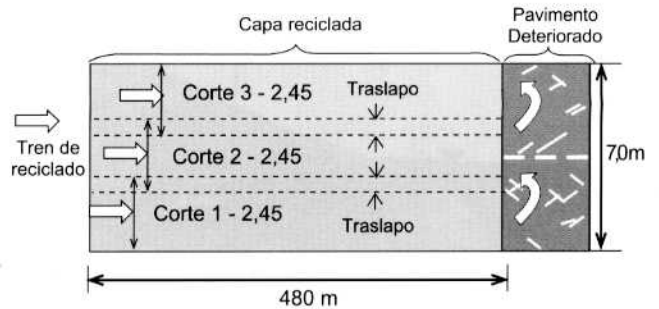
Secuencia del tren de reciclado en calzada completa, vista en planta
